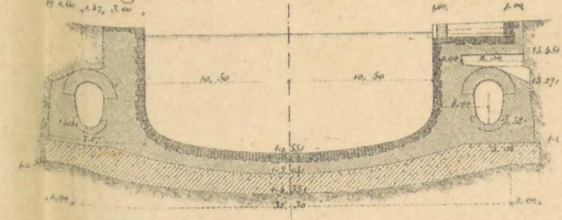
Demi-Élévation d'aval et demi-coupe 13.
